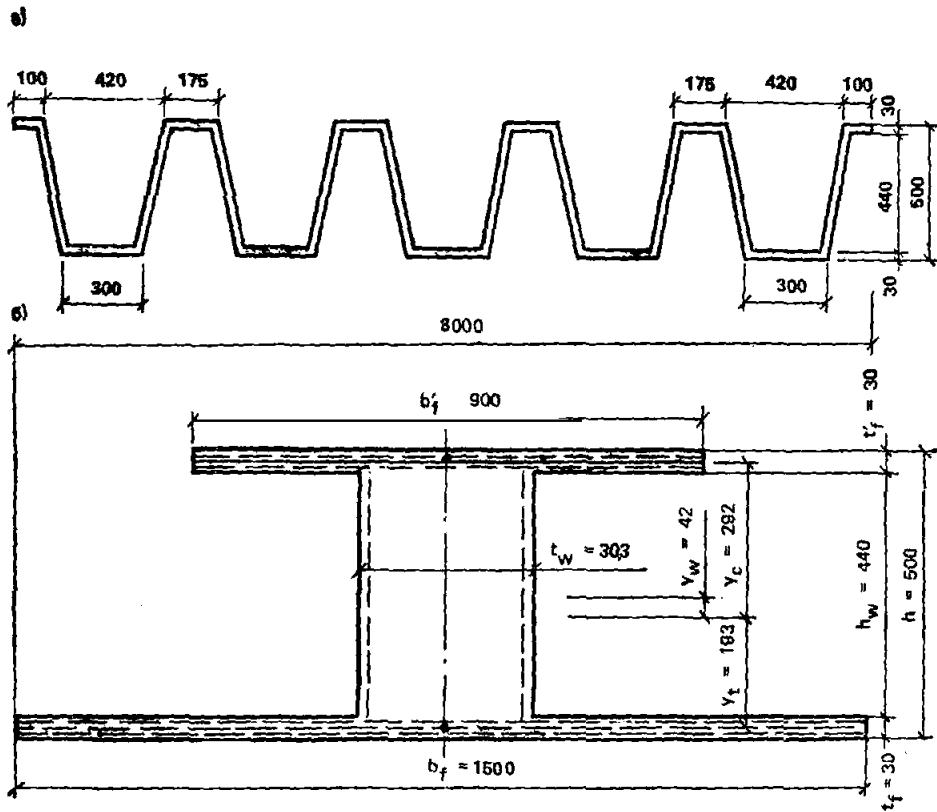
Сечения армоцементной складчатой плиты покрытия
